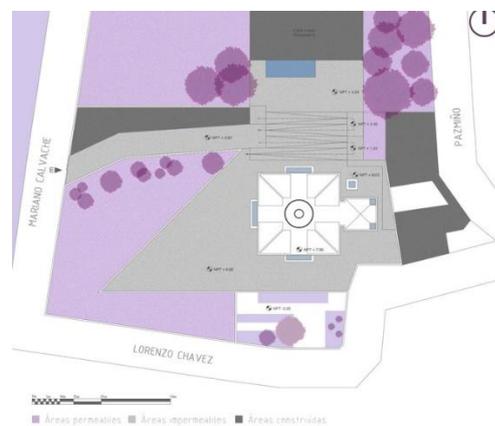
Planta arquitectónica del Museo La capilla del hombre. Fuente: (Galàrraga, 2021)
